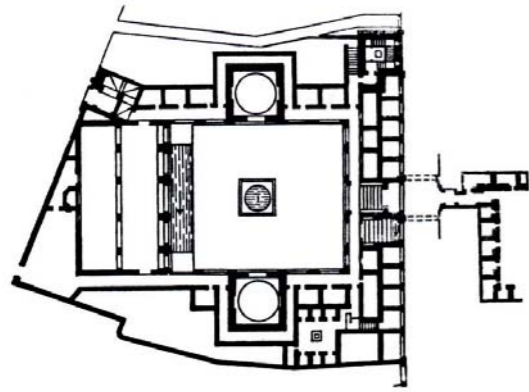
Madrasa Bû-Ināniyyah, Fez, 1350/55. Planta.
